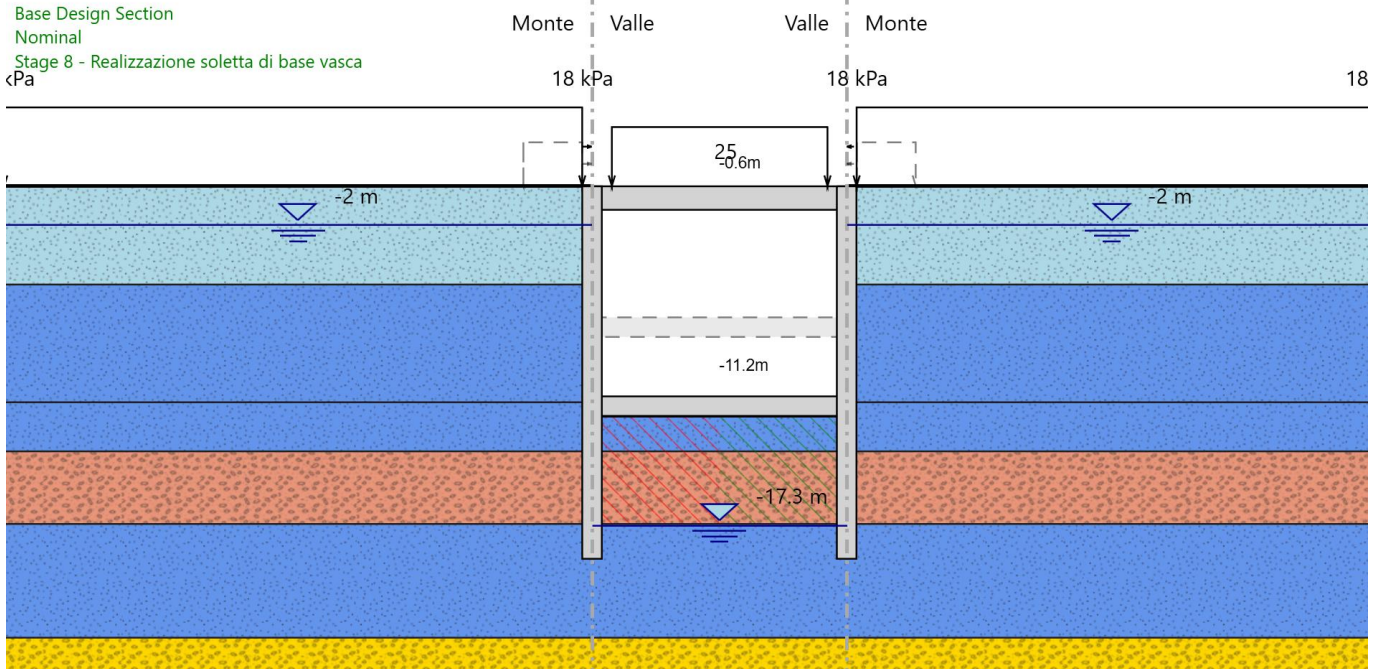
Fase 8: Realizzazione soletta di fondazione
